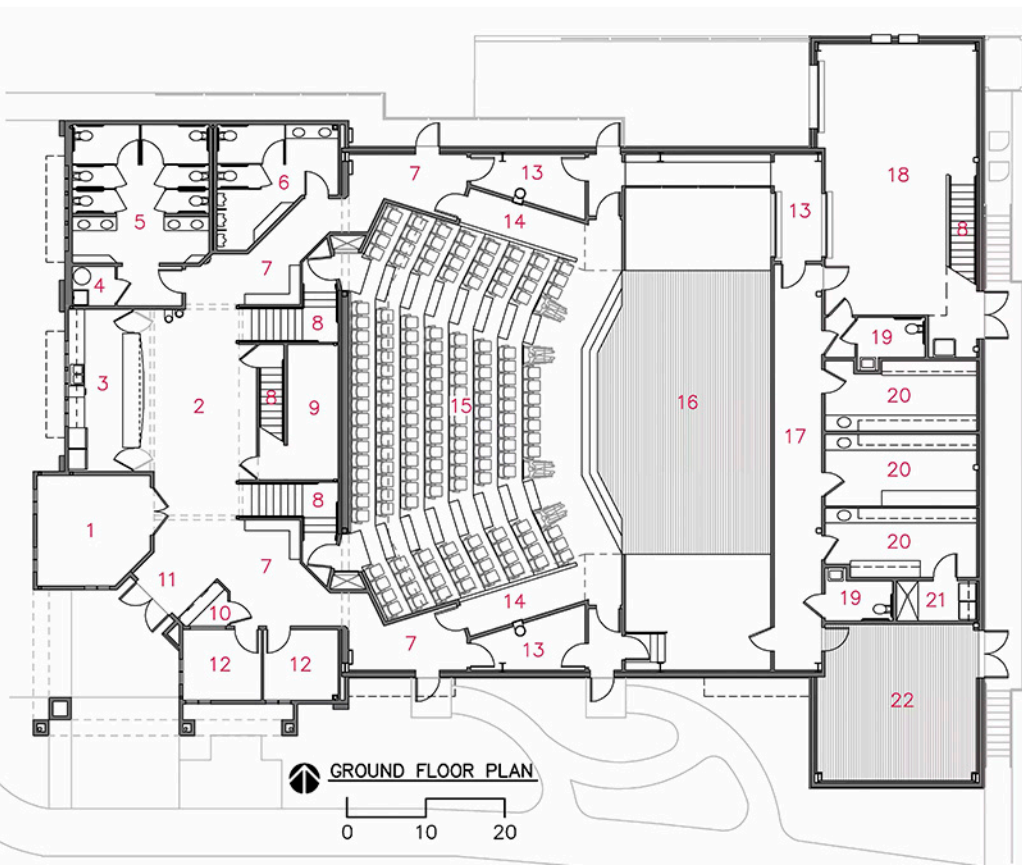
Bruce Richey, Plano Planta Del «Camelot Theatre» (Talent, Ontario)
